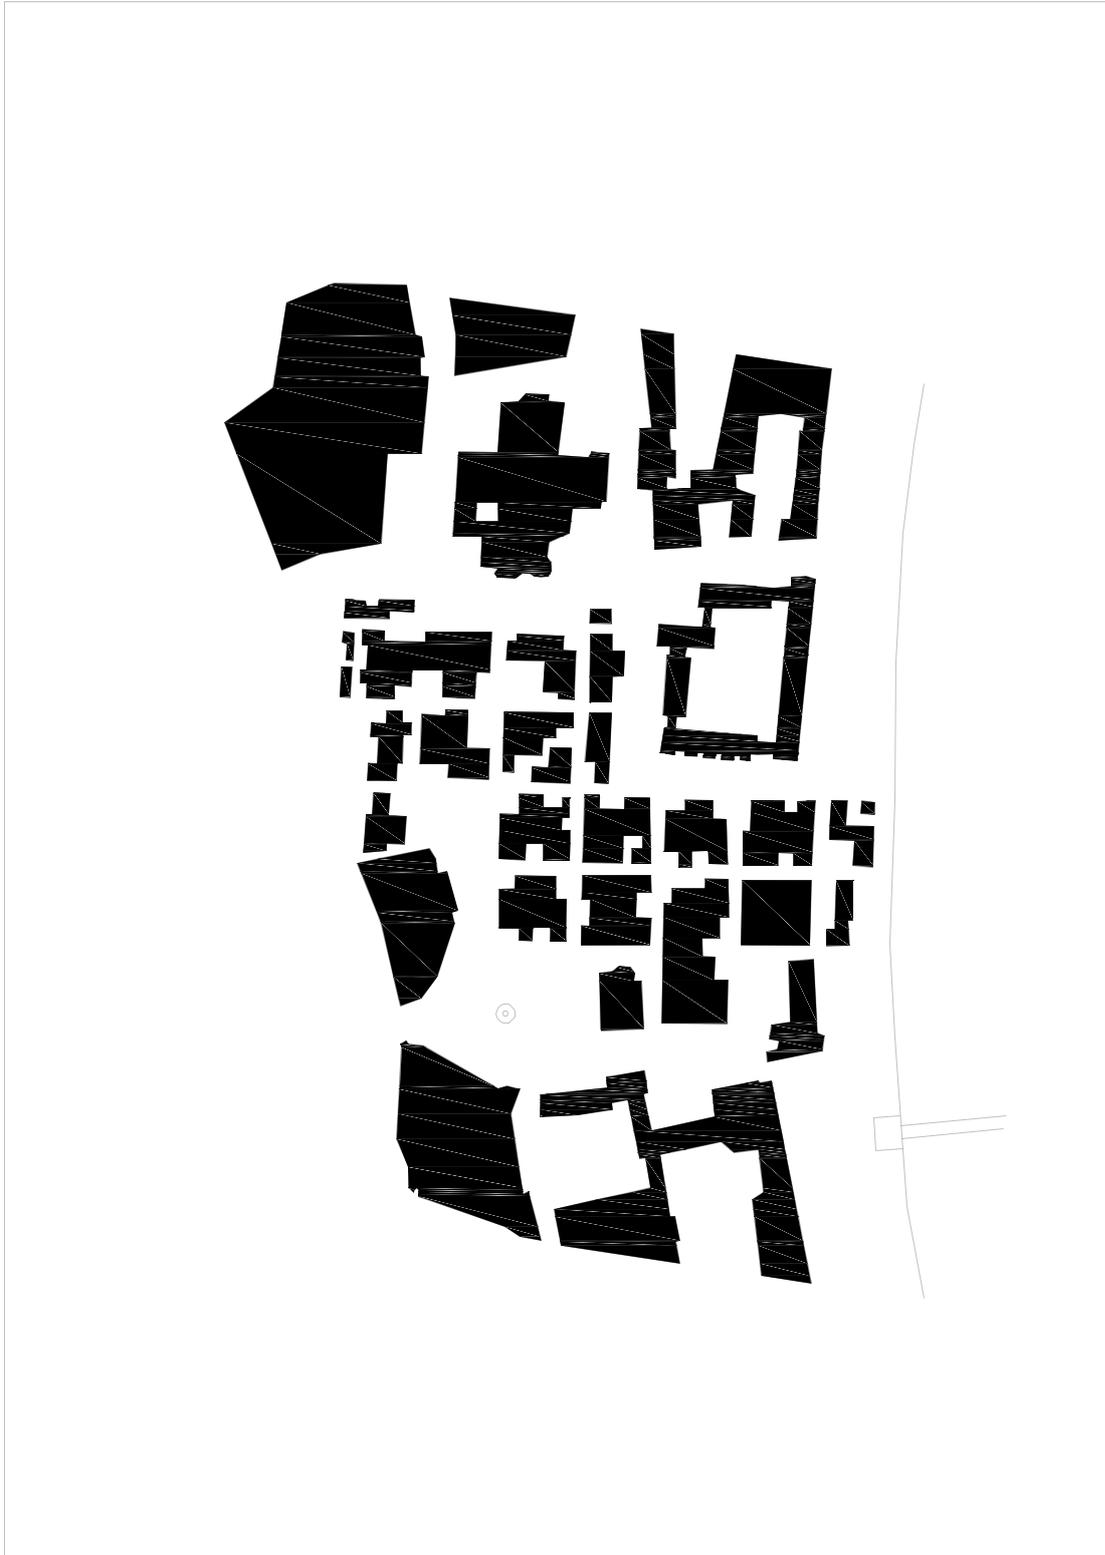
Planta de Frankfurt-Römerberg, propuesta de Candilis, Jozic y Woods (1963), esquema de planta baja.
